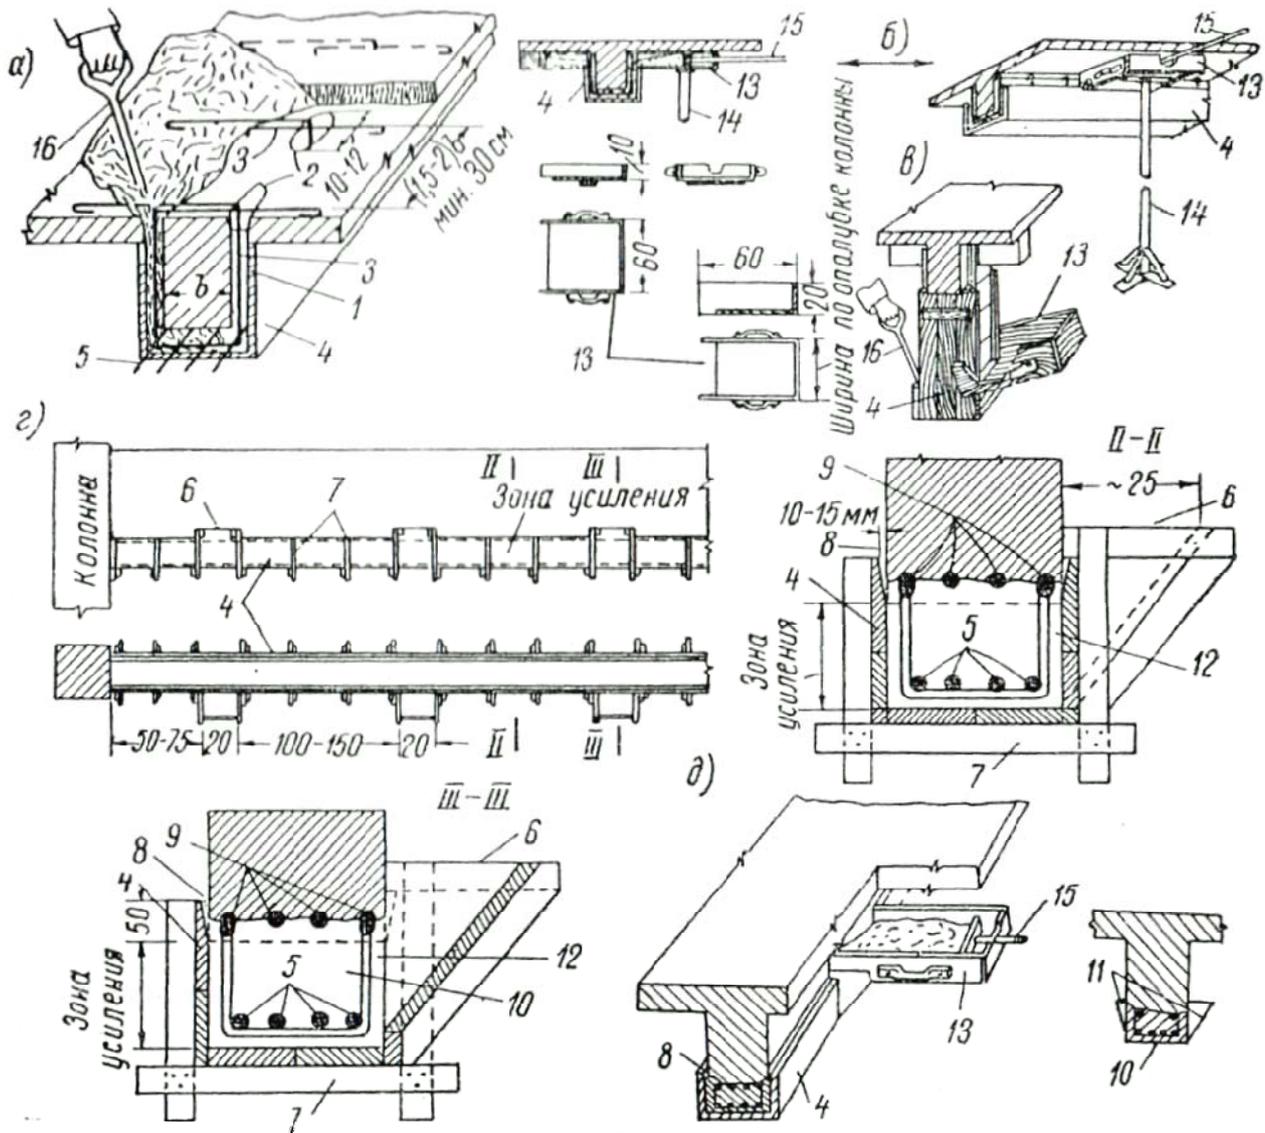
Бетонирование обоймы, рубашек или наращиваний при усилении железобетонных элементов:
